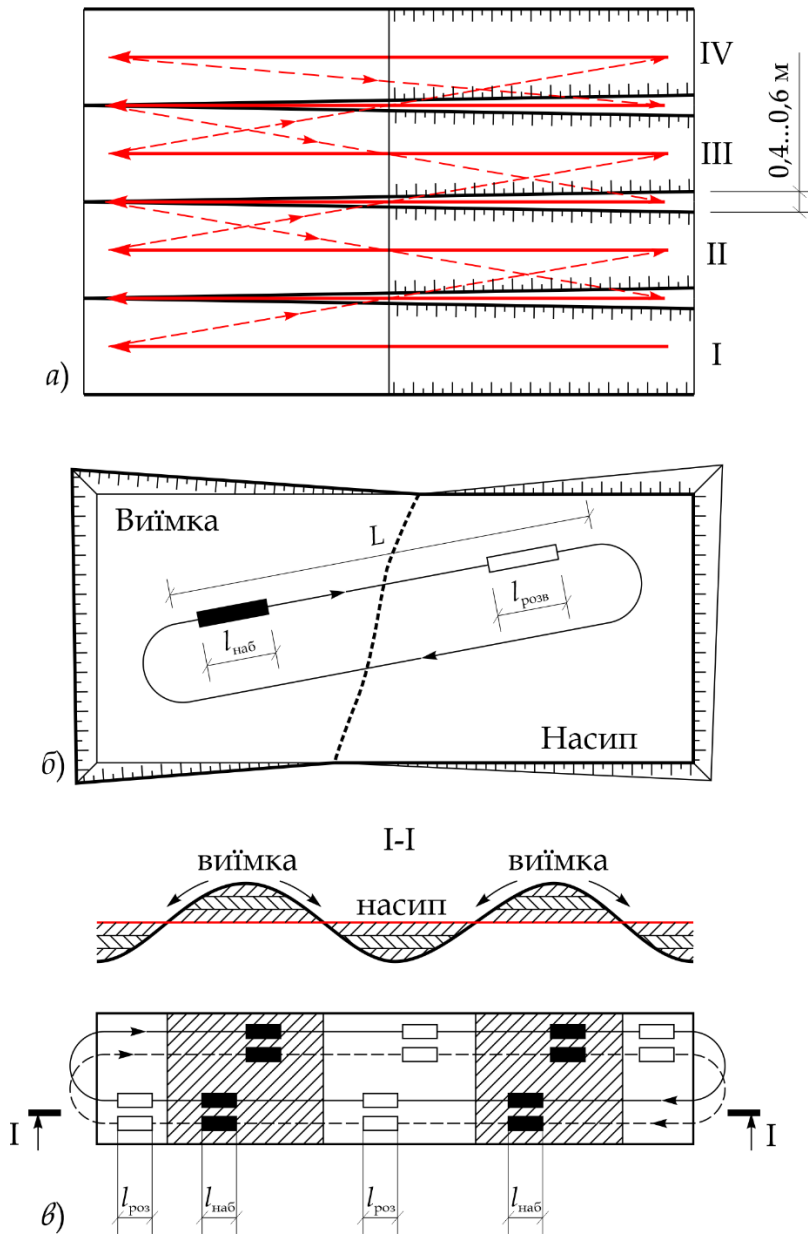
Схемы перемещения грунта при планировке площадок бульдозерами и скреперами:
